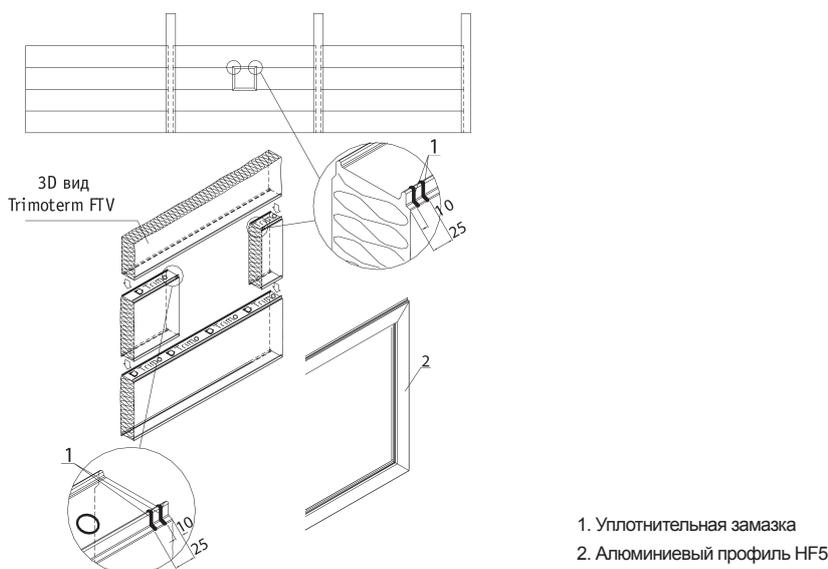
Плоский и базовый алюминиевые профили HF5/2 и HF5/1
